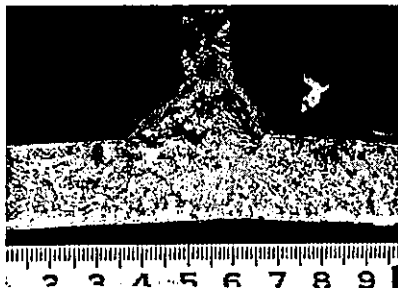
脆性的に破断したフランジの破面 (BH-1)
